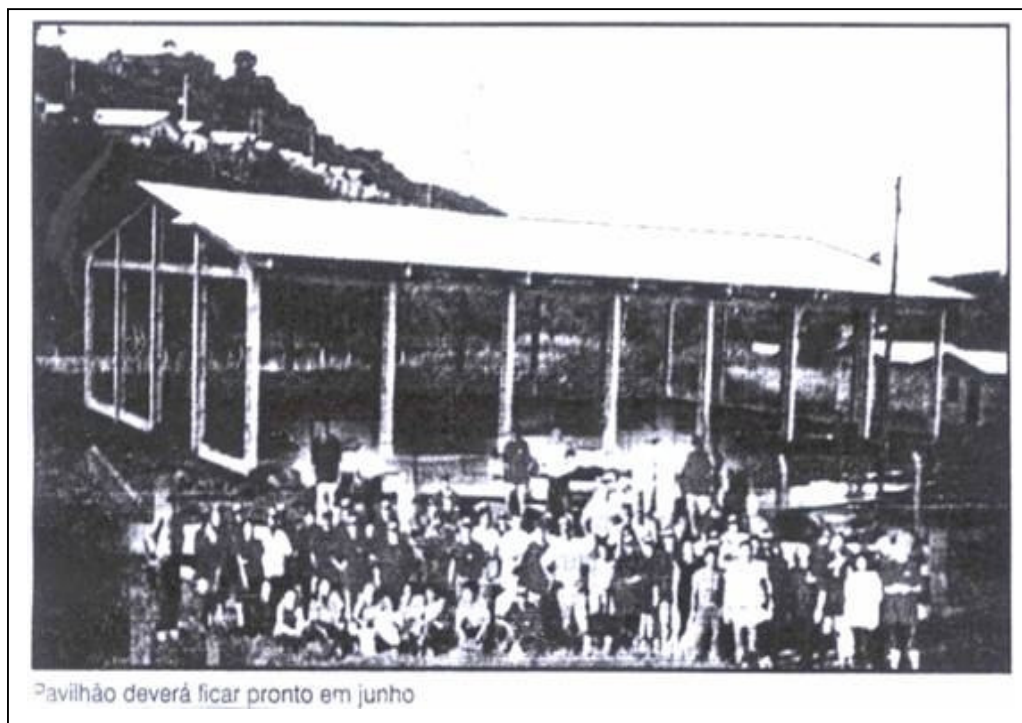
INSTALAÇÕES DA ARCAN EM CONSTRUÇÃO.
